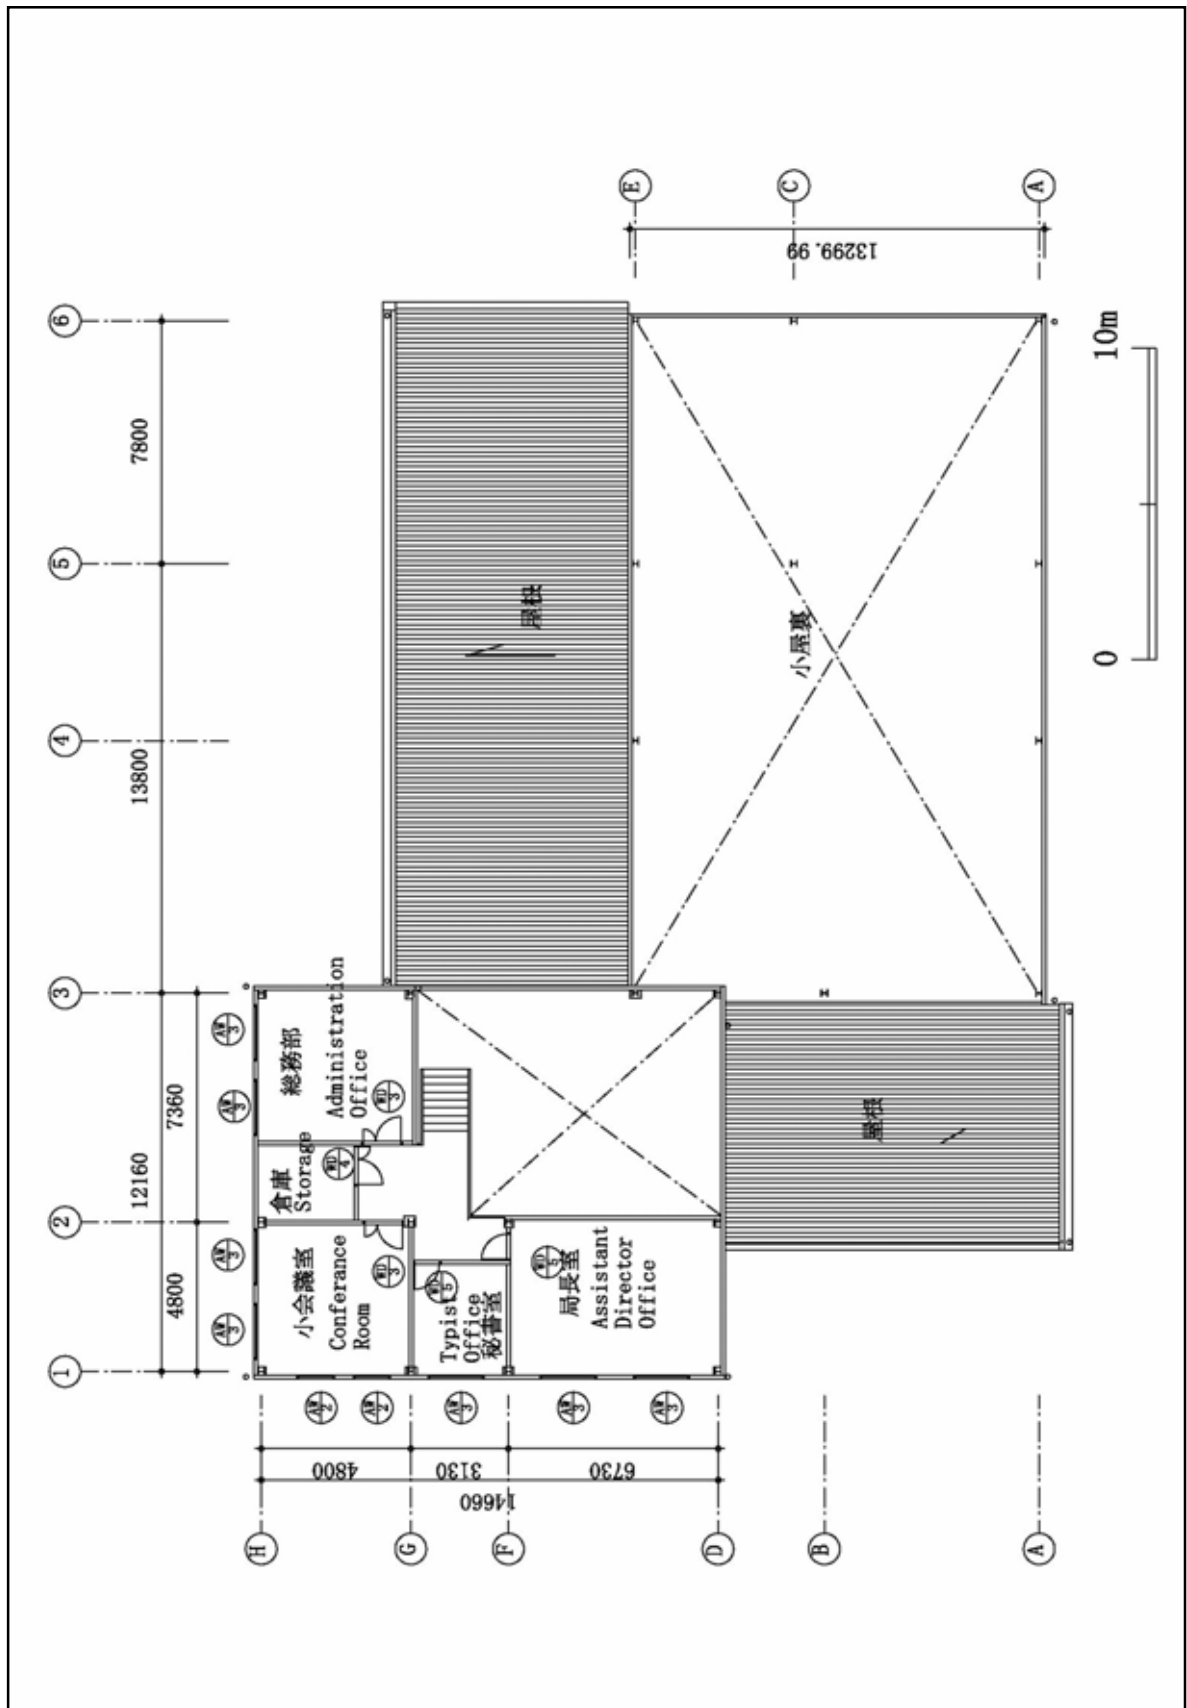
(14) 水産センター管理棟中 2 階平面図
